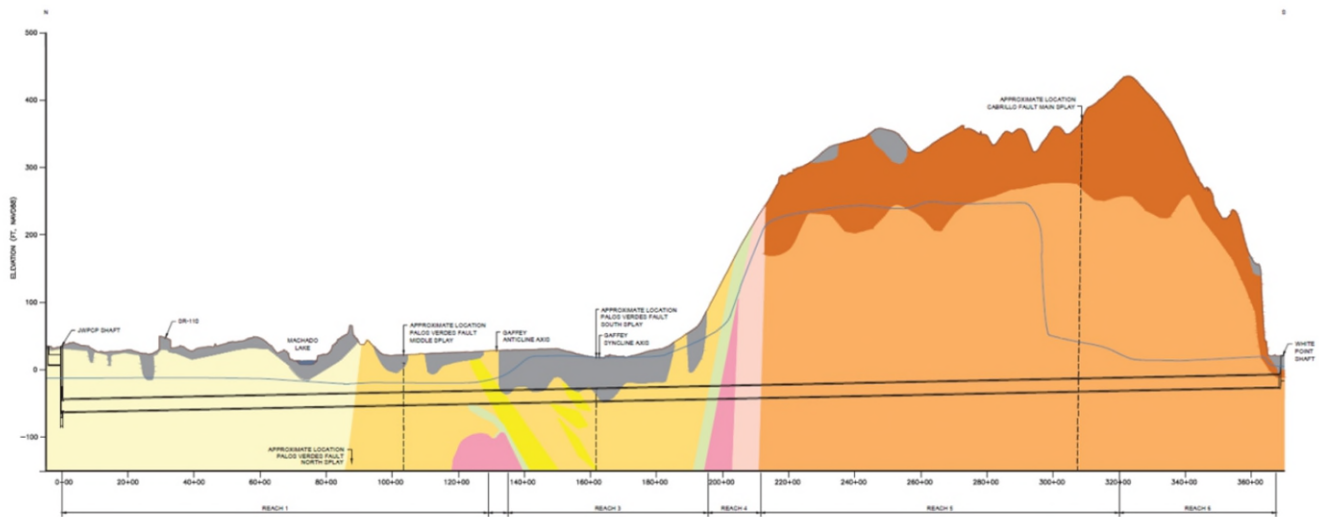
Perfil geológico de Los Ángeles Effluent Outfall tunnel
